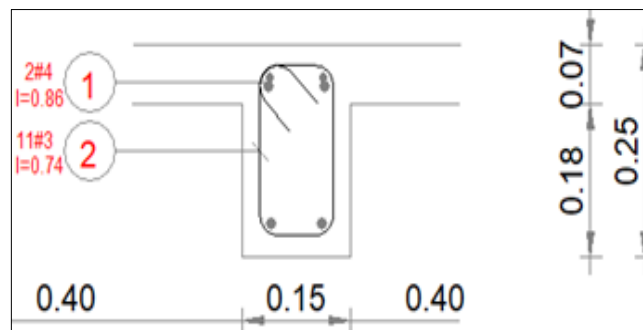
Sección del nervio de la losa nervada, separadas cada metro de eje a eje.
